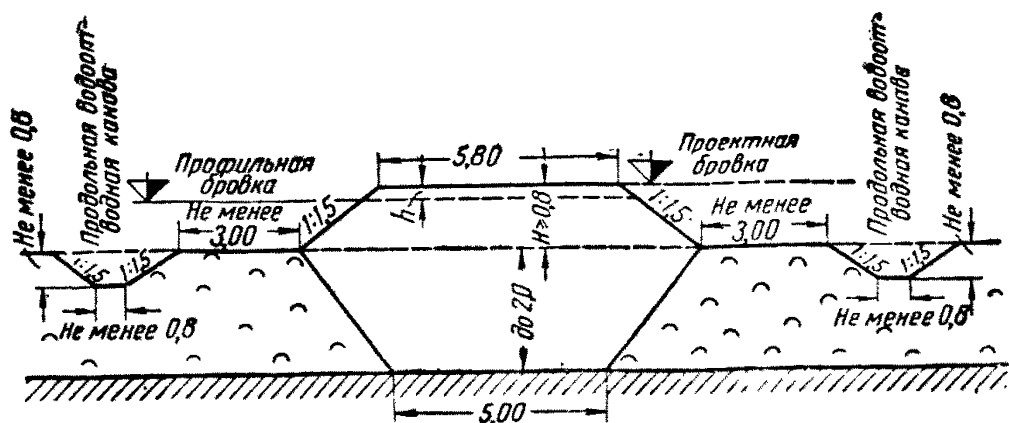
Насыпь из дренирующих грунтов высотой 0,8—3 м на болотах I типа с погружением на минеральное дно при поперечном уклоне основания не круче 1:10
